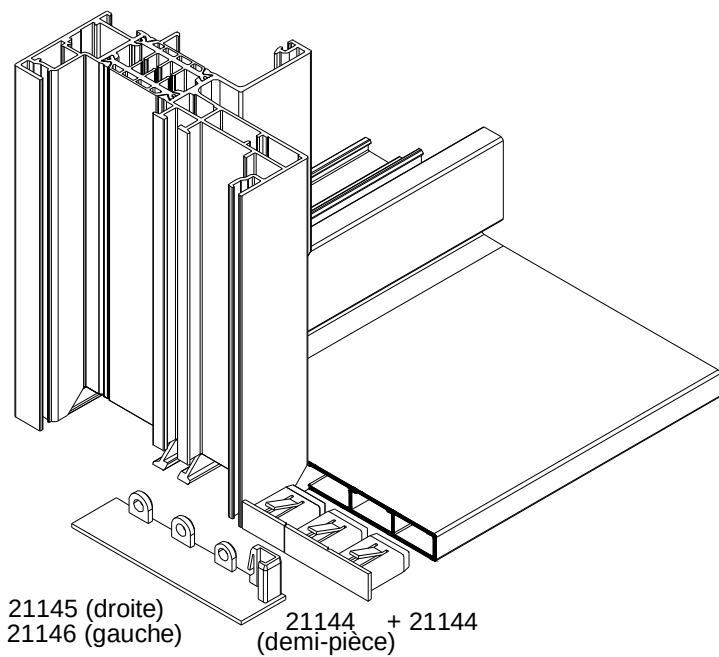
DETAILS D'ASSEMBLAGE / ETANCHEITE DORMANT
